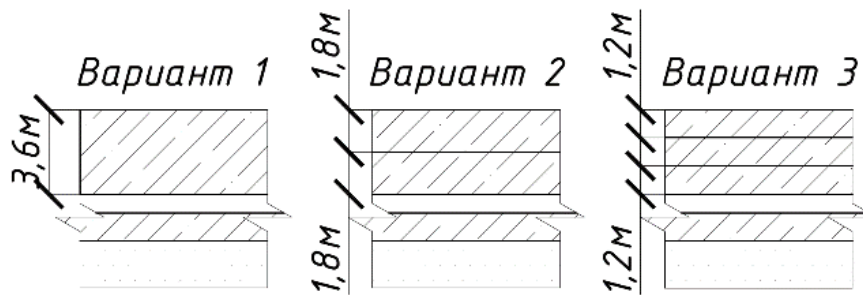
Варианты деления массивной фундаментной плиты ВЭУ на блоки бетонирования
